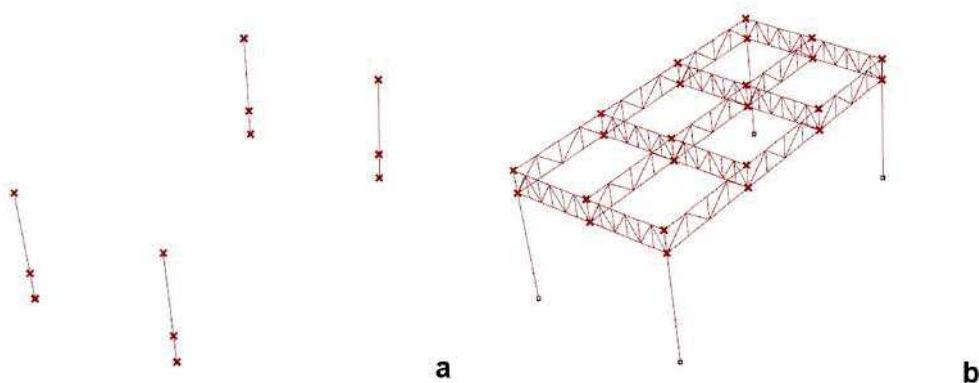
Definizione degli assi degli elementi componenti i pilastri (a) e le travi della copertura (b; da Basso 2018)
